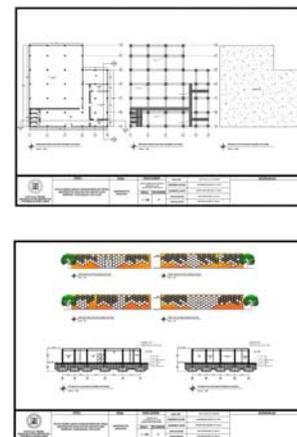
Bangunan *Café and Coffe Shop
